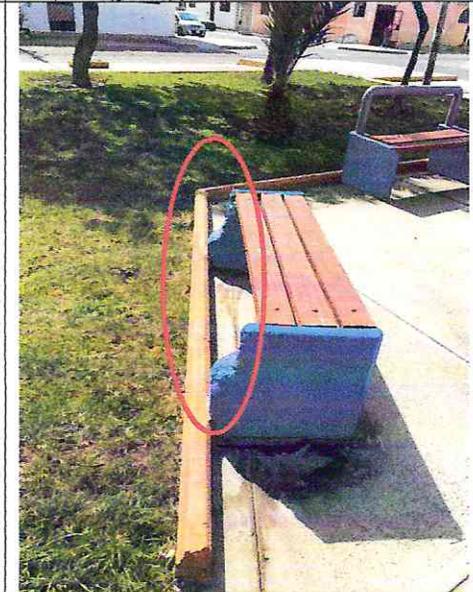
Banca de concreto con ausencia de espaldar.
